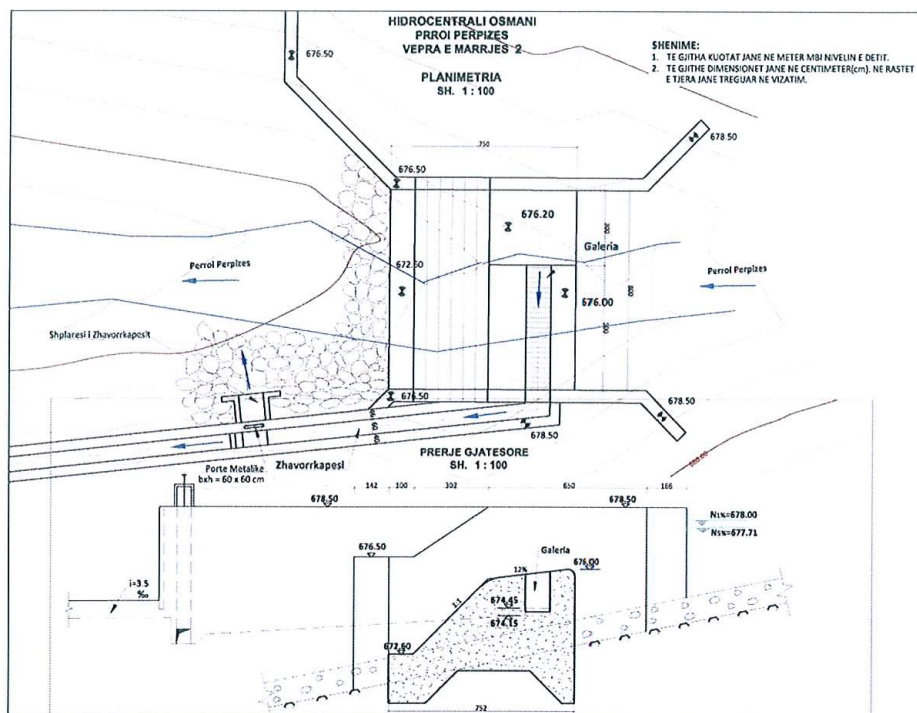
Planimetria dhe Prerja Gjatësore e Veprës së Marrjes VM – 2, në përroin e Përpizës
